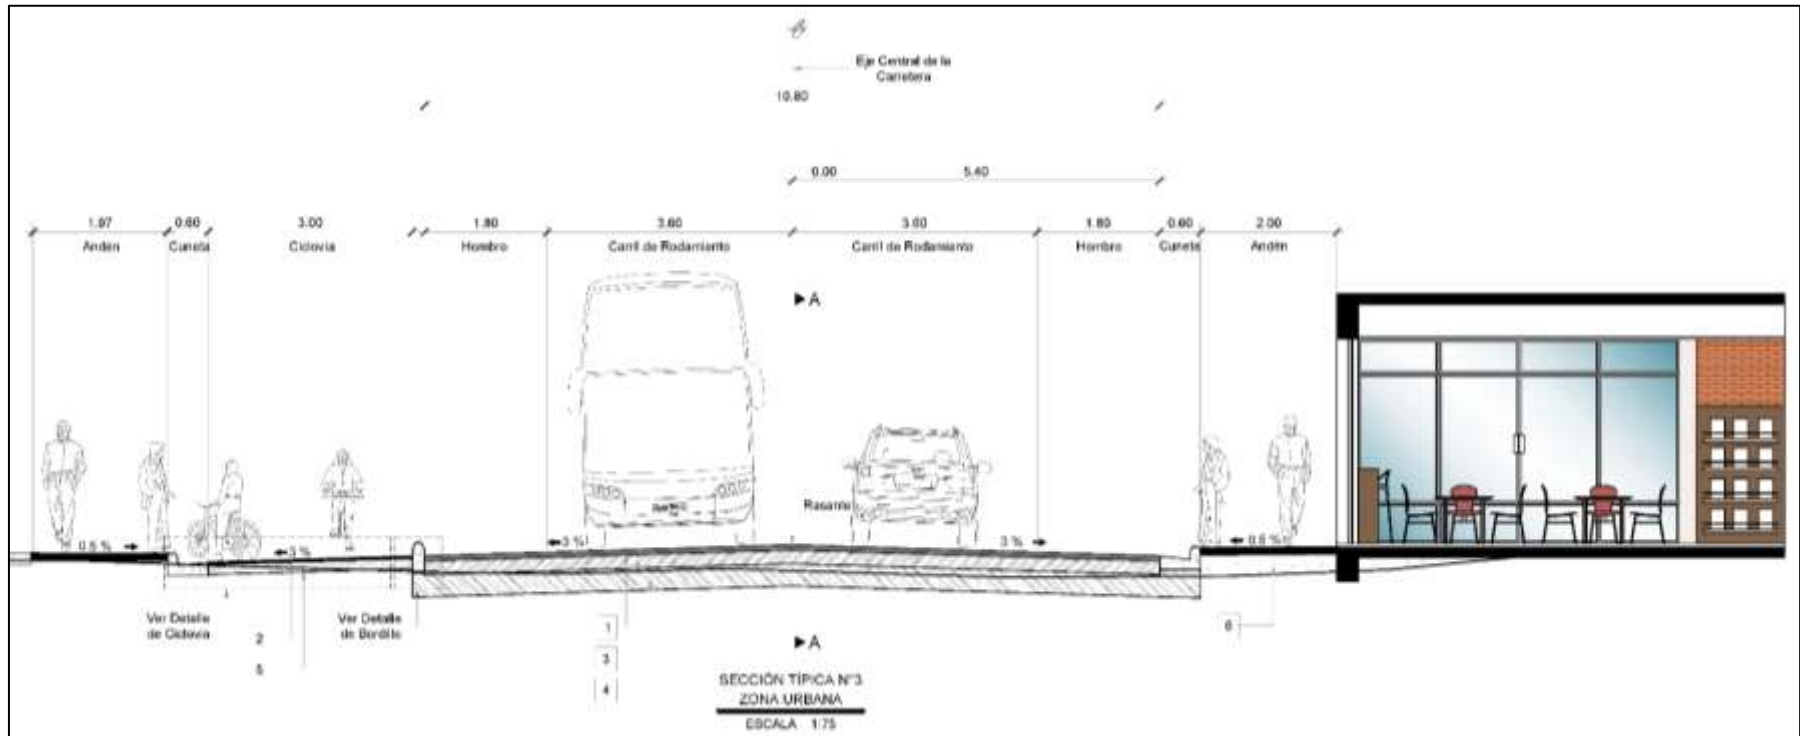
Propuesta de Sección Típica Transversal Zona Urbana
